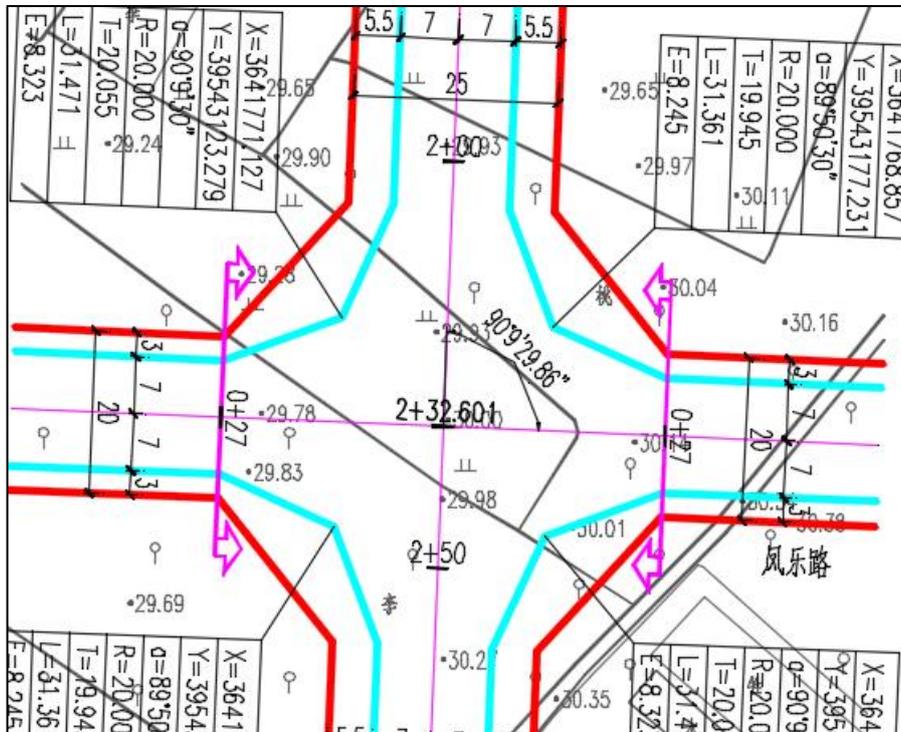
风乐路与龙秀路交叉口交通组织平面图
